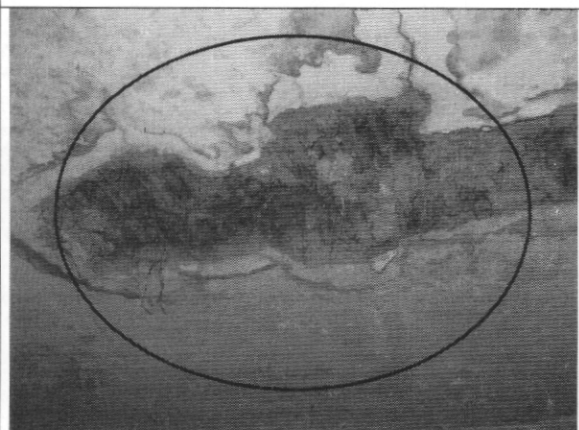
Deterioro en cielo raso bajo cubierta, costado sur
